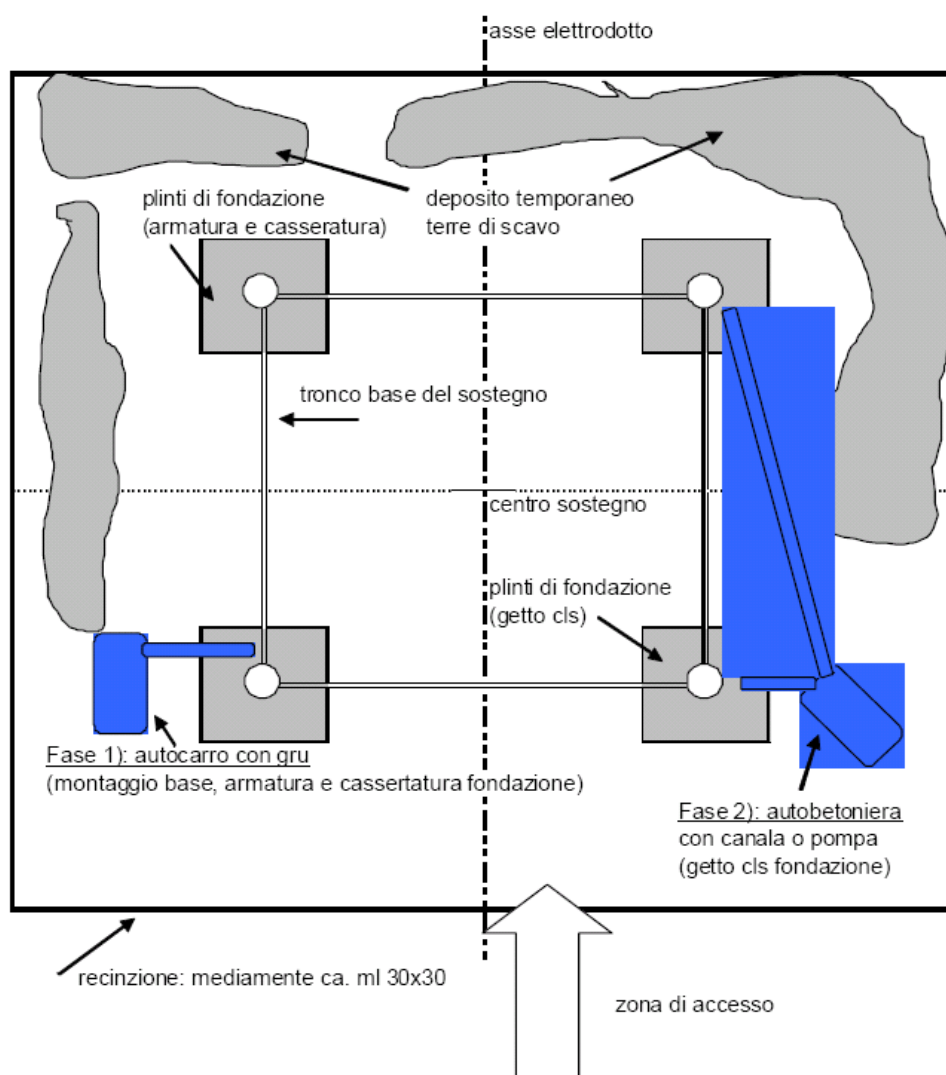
Planimetria dell'area di sostegno (getto e basi)
